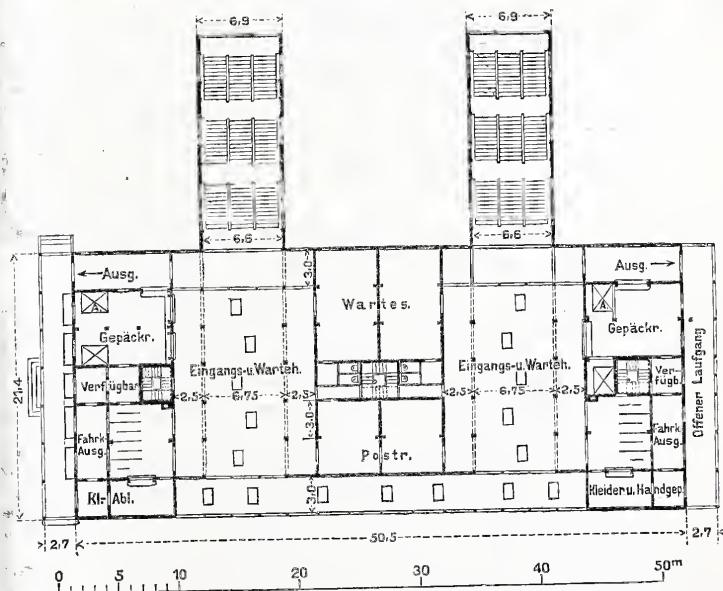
Bahnhof Österbro. Grundriß in Straßenhöhe.
